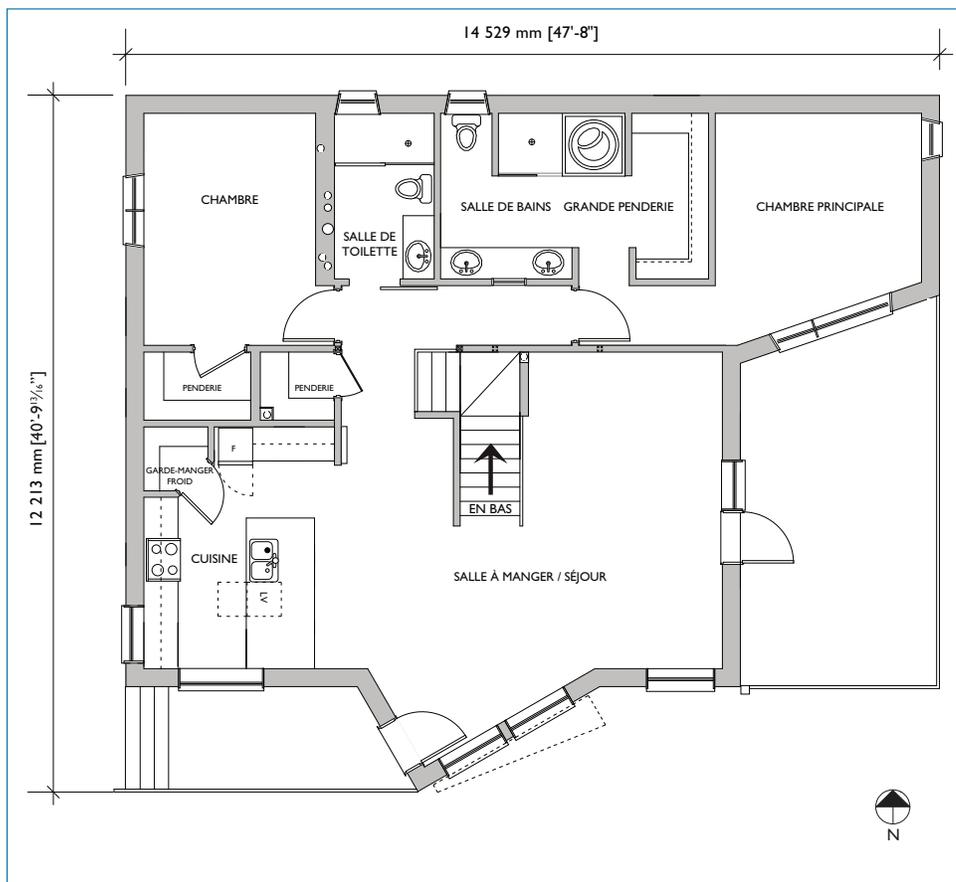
Plan du rez-de-chaussée de la maison EQUilibrium^{MC} EchoHaven
